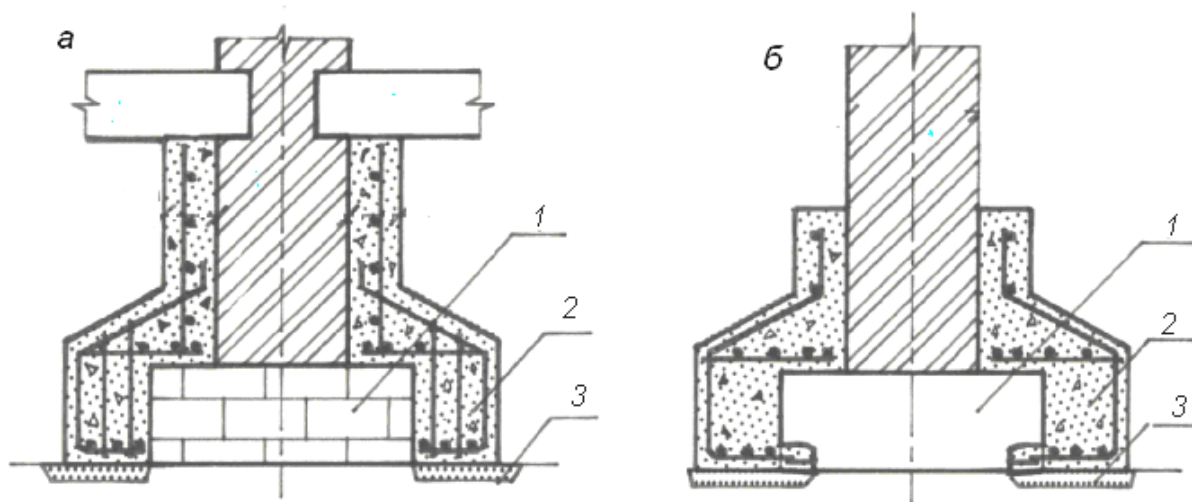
Уширение подошвы столбчатого фундамента железобетонными обоймами: а – с упором в элемент перекрытия подвала; б – с приваркой к арматуре фундамента: 1 – существующий фундамент; 2 – обойма; 3 – подготовка
